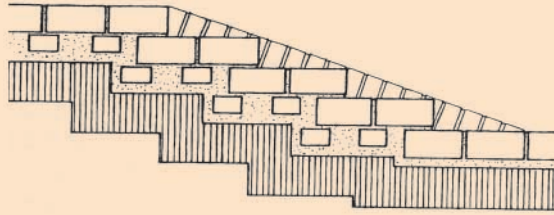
Adoquines cerámicos de pavimento acoplados, con inclinación hormigonada, a la zona de mampostería.
